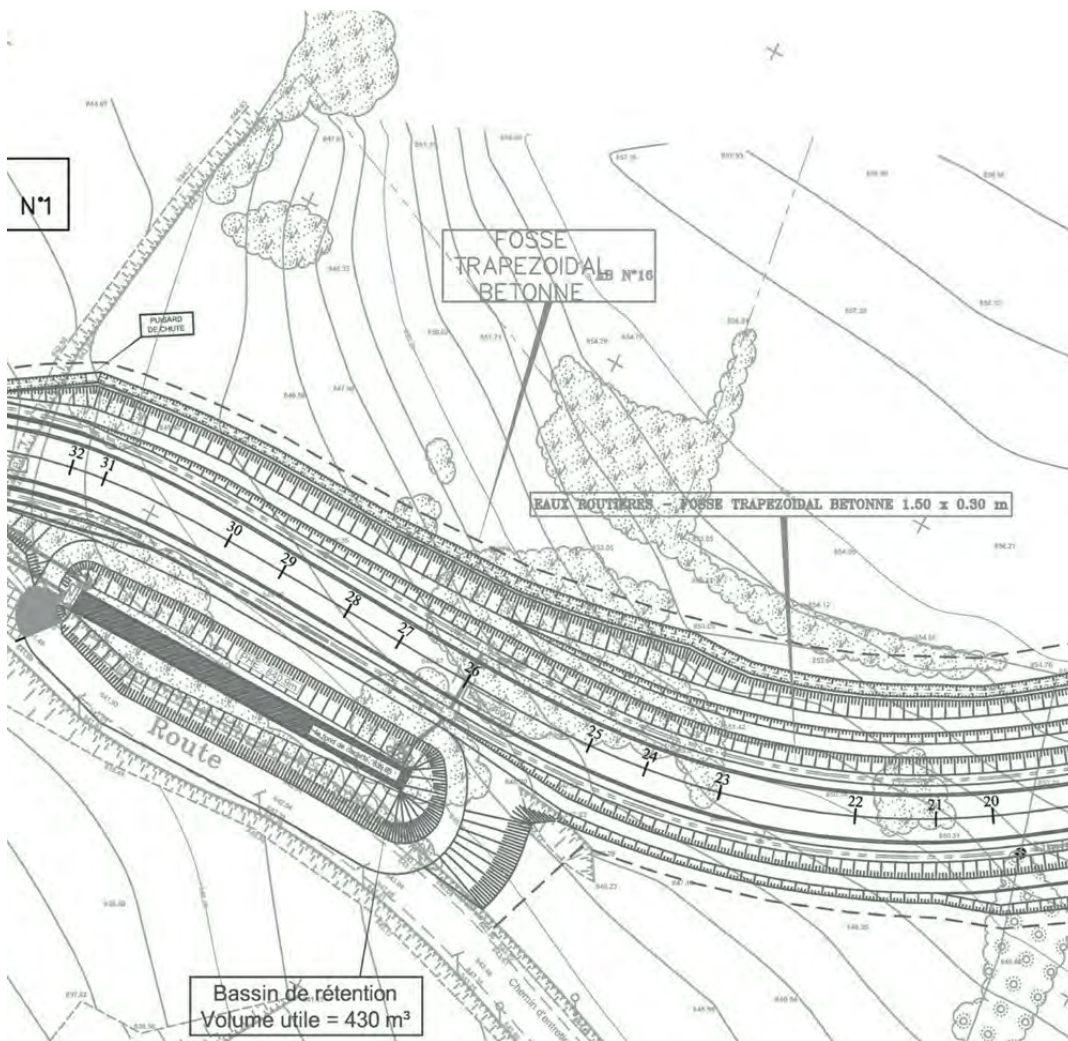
Extrait d'un plan d'assainissement. (Voir cahier couleur p.90-91)
